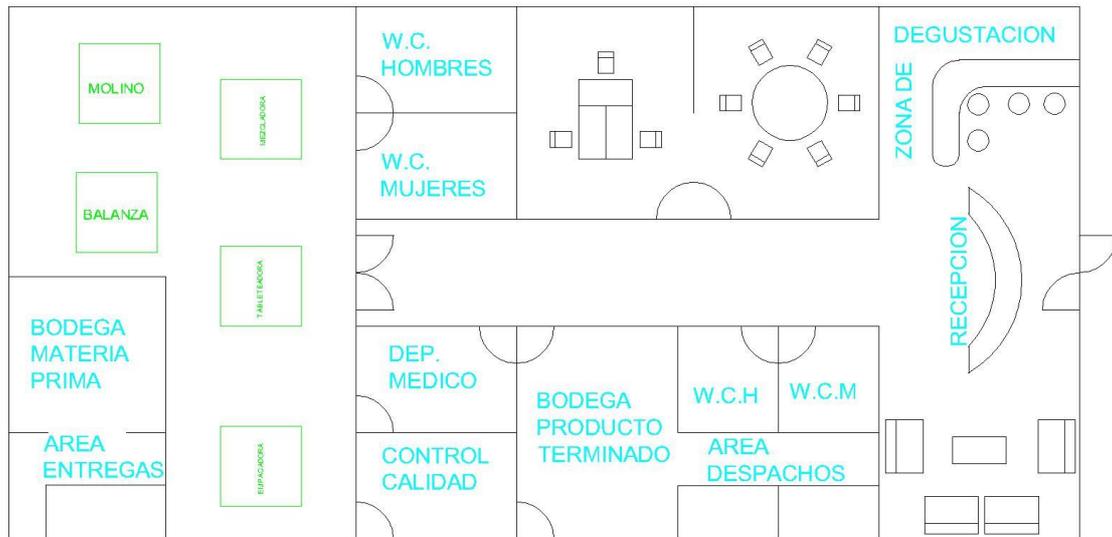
Plano de distribución de planta Empresa SOPRA S.A.
